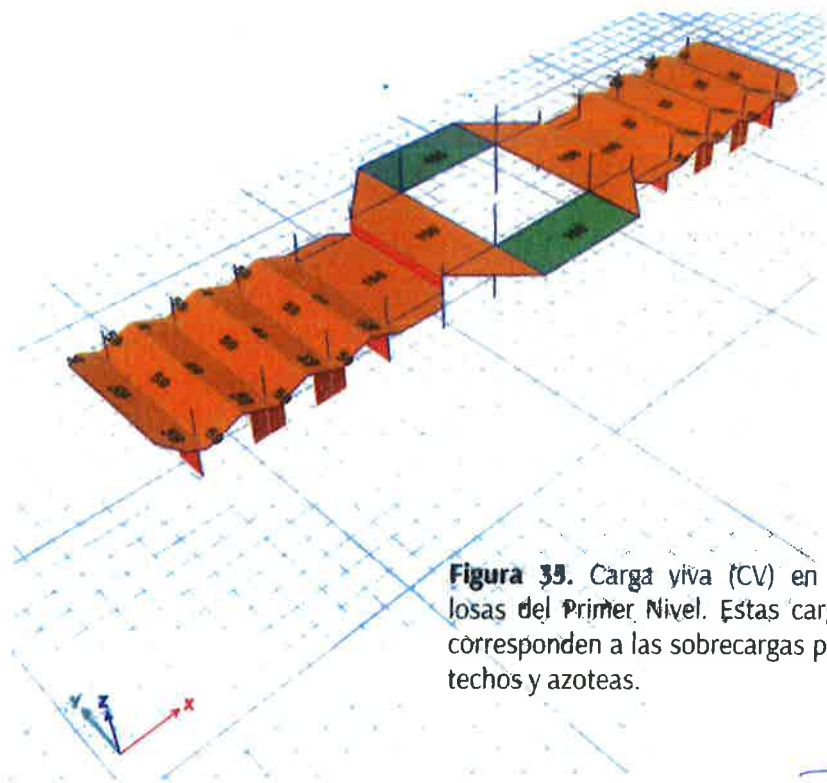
Carga viva (CV) en las losas del Primer Nivel. Estas cargas corresponden a las sobrecargas para techos y azoteas.
